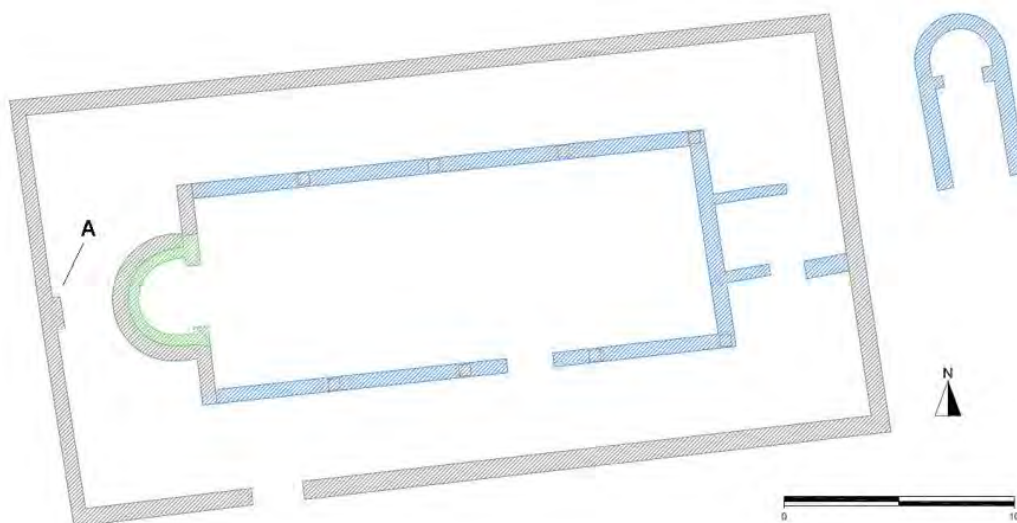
Planta de la basílica del Coracho (Lucena, Córdoba) (del autor).
